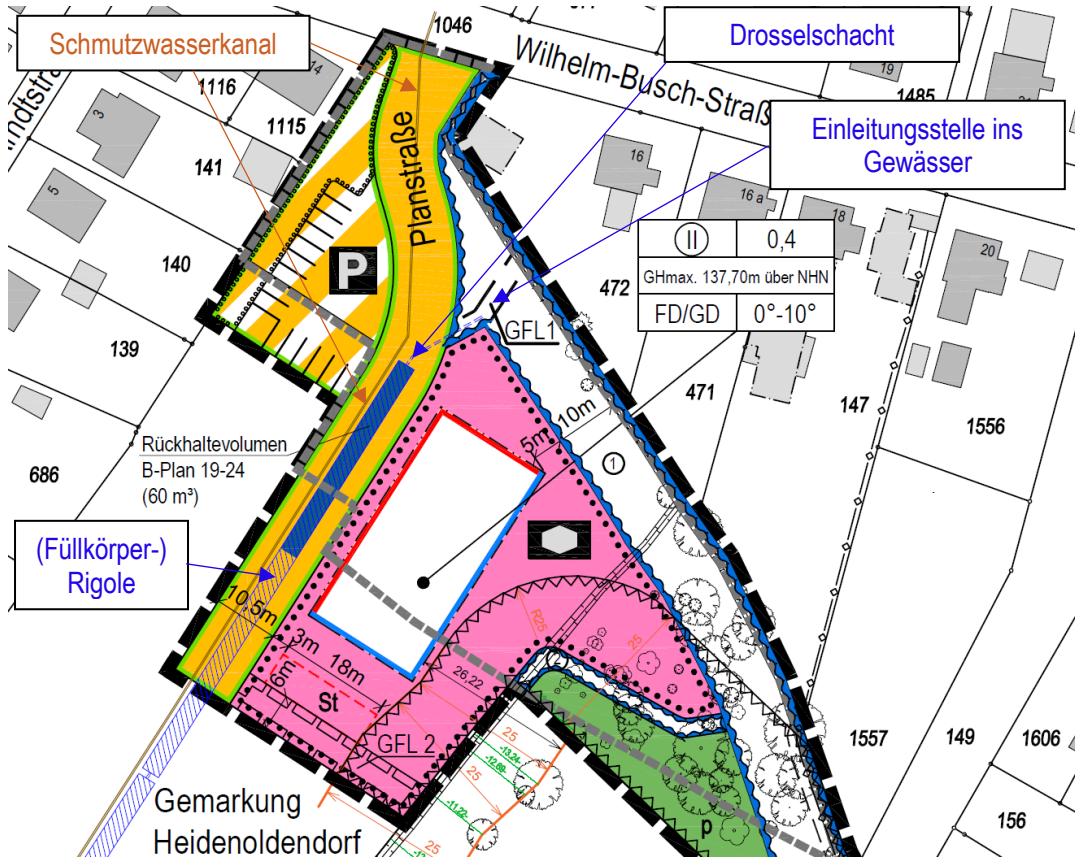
Entwurf des Bebauungsplans 19-24 mit Entwässerungskonzept (Gewässer Nr. 28 am nordöstlichen Plangebietsrand)
